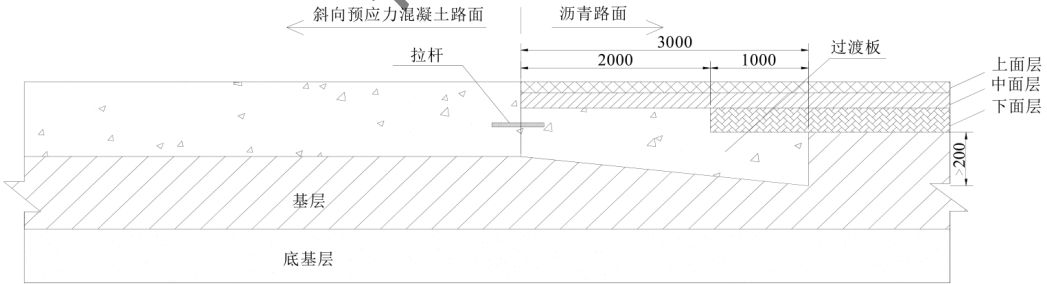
斜向预应力混凝土路面与沥青路面相接段的构造布置
